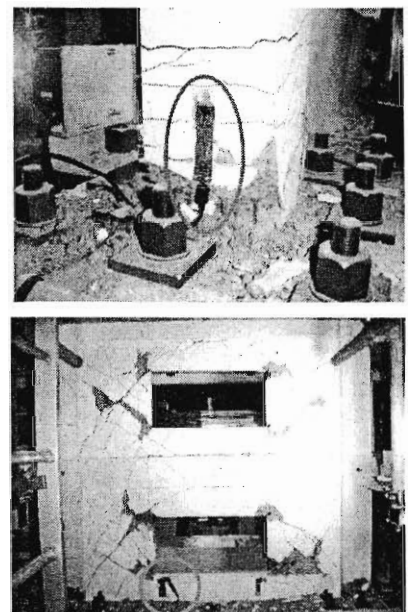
センサ設置周辺の模型ひび割れ状況 (上：センサ A、下：センサ E)
